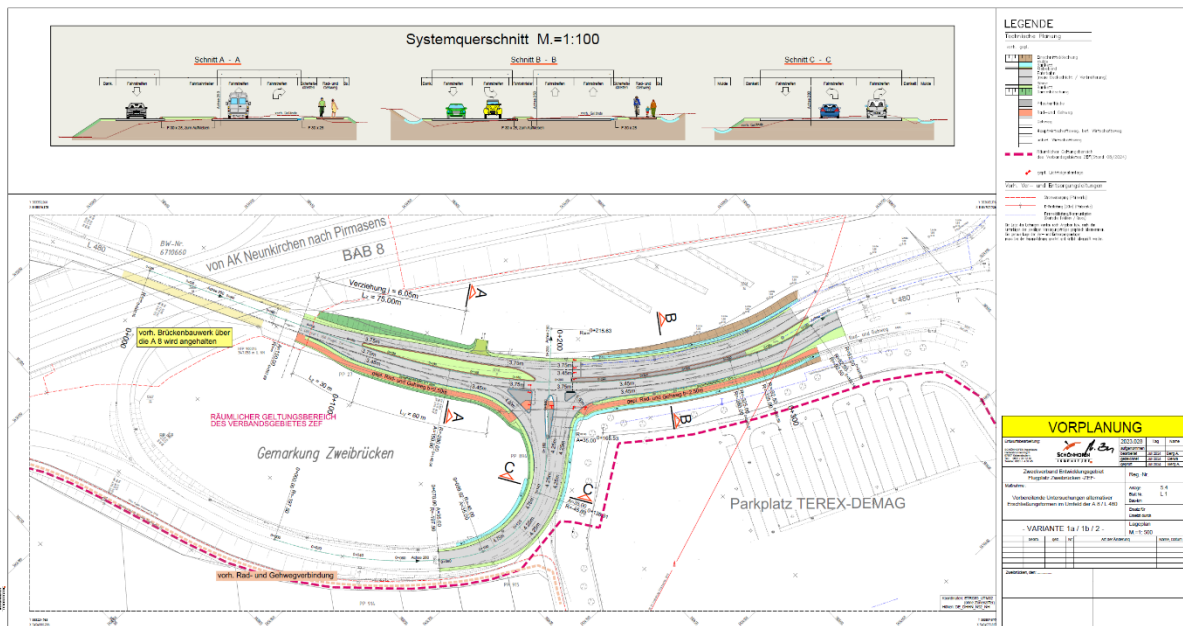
Anschlussknoten BAB 8/L480 – neu: Abgrenzung des planfeststellungsersetzenden Teils des Bebauungsplans (gestrichelt rot) – Teilbereich SÜD, Schönhofen Ingenieure, 07.10.2024
